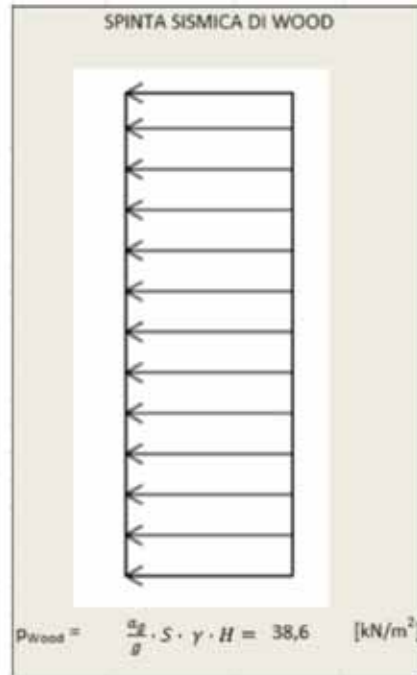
SPALLE A e B – Spinta Sismica Wood
